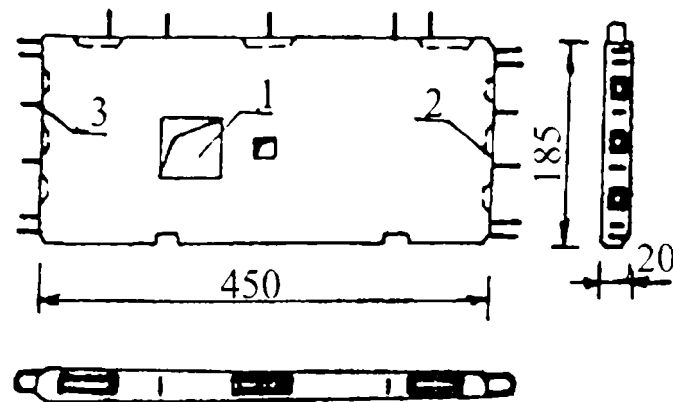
Panou prefabricat pentru elevații: 1 - gol pentru instalații; 2 - alveole; 3 - bucle pentru îmbinări.
